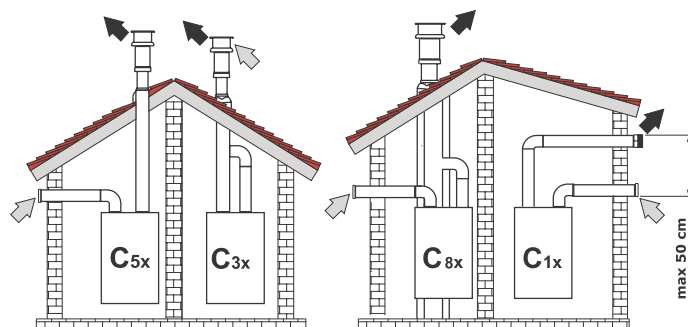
Voorbeeld van een aansluiting met aparte leidingen
